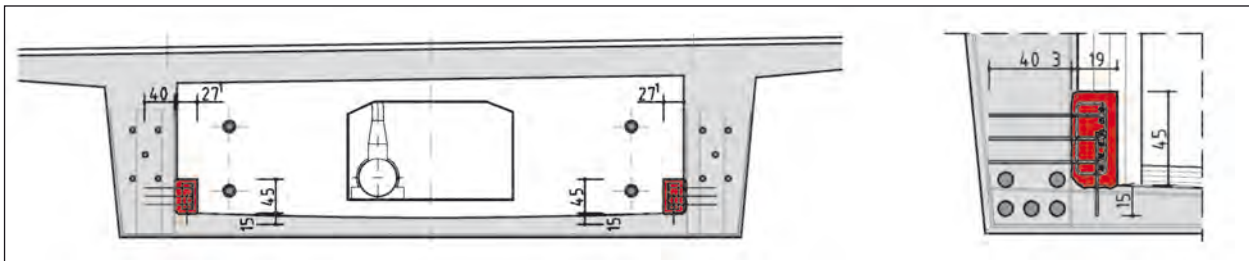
Ortbeton-Verstärkungsblöcke im Querschnitt (links) und im Detail (rechts)
